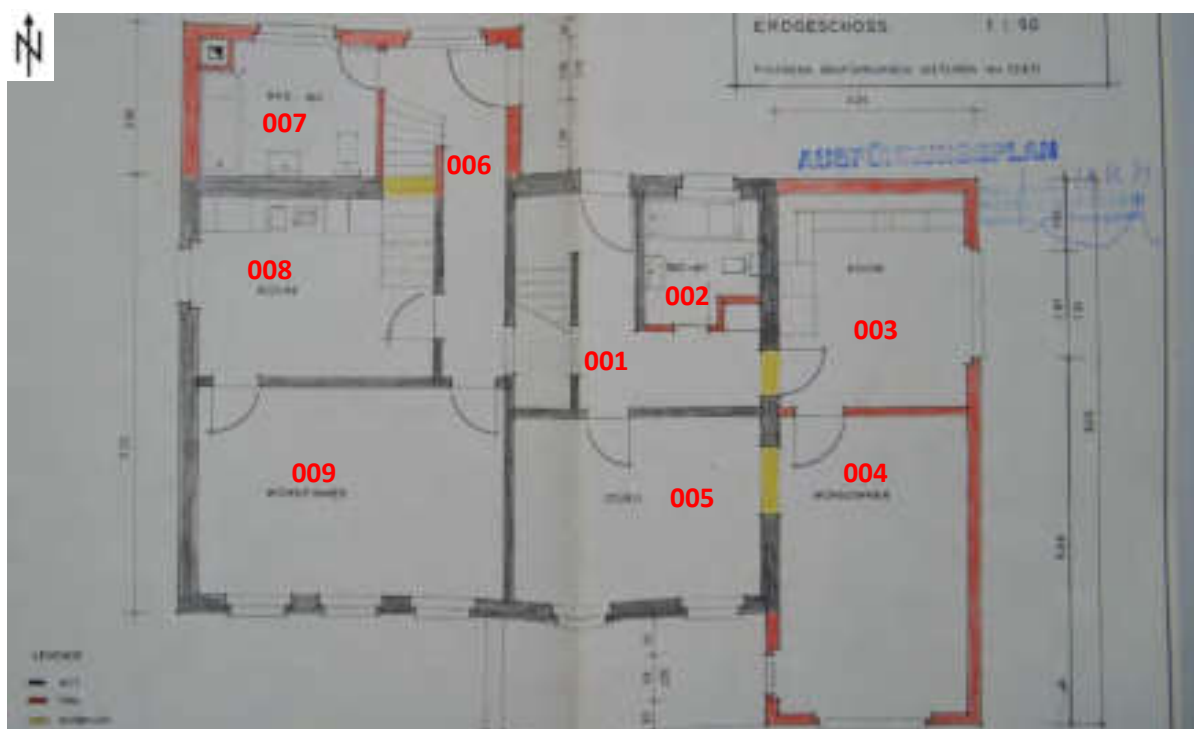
Grundriss EG. Quelle: GdeA.
